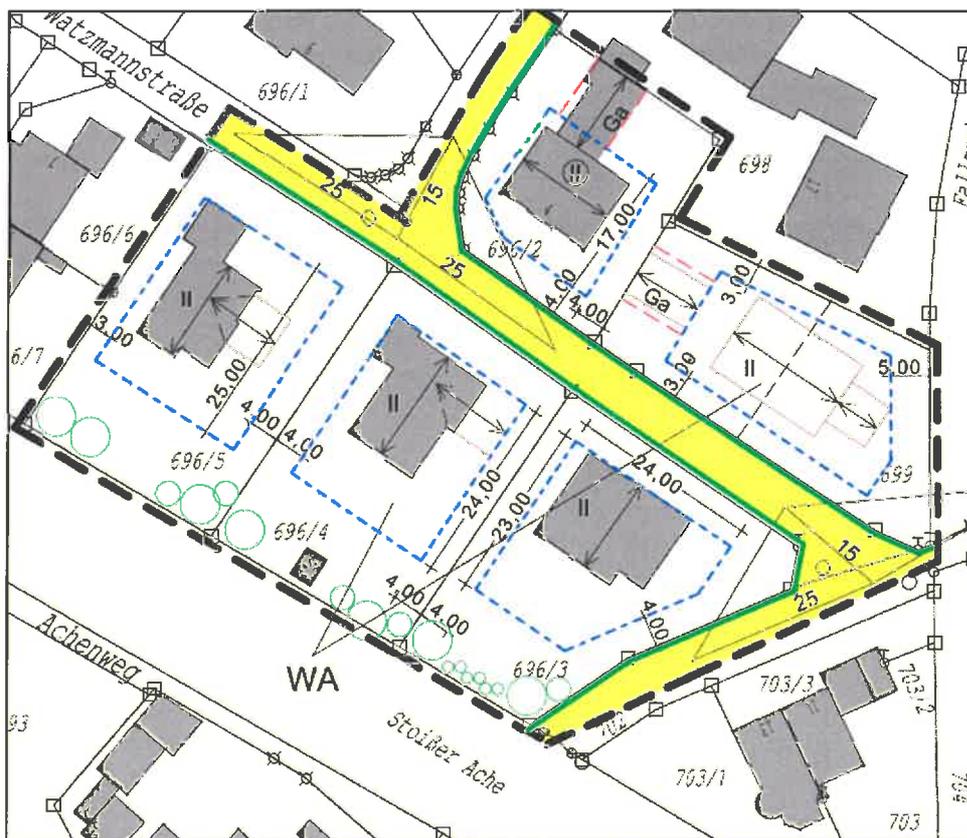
Vorgeschlagene Bebauungsplanänderung (IB Lerach, Planstand 03.11.2016)
